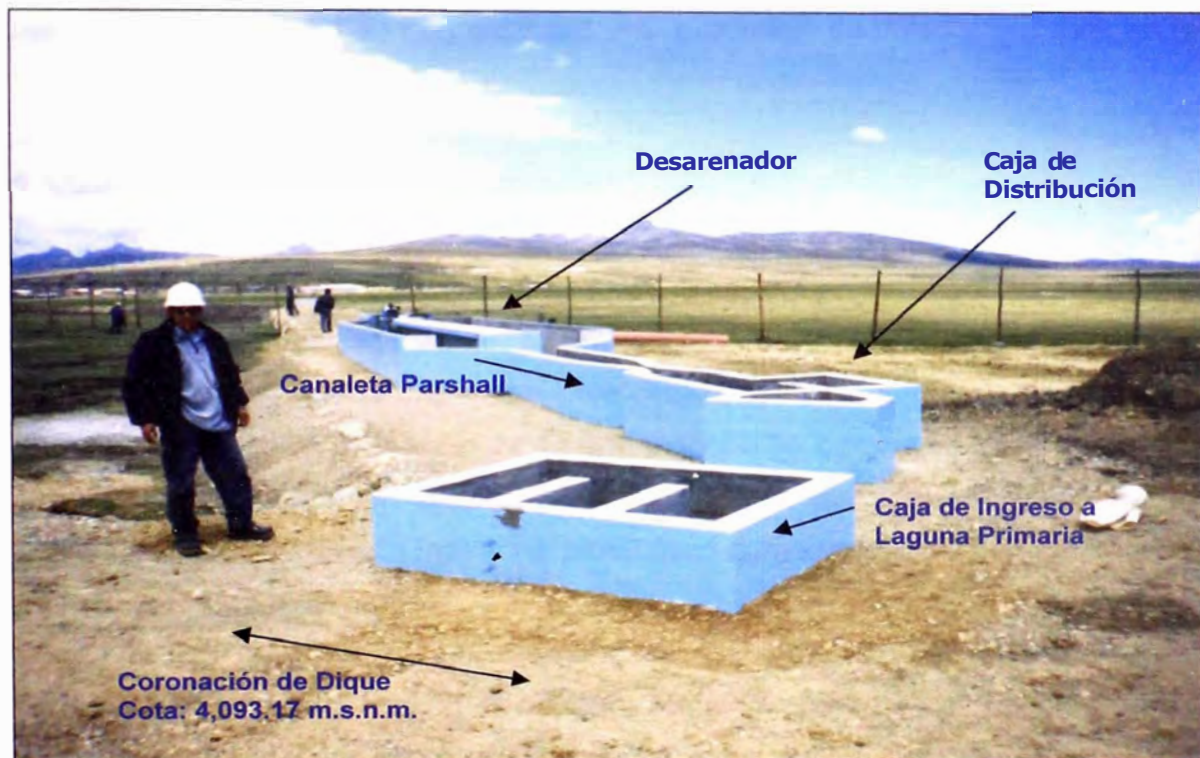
Vista de los elementos de concreto armado al ingreso de la laguna primaria, tarrajeados y pintados respectivamente.
